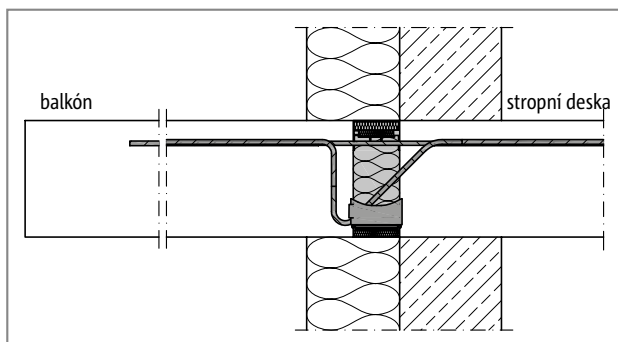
Schöck Isokorb® T typ KL a typ QL: Lodžie uložena ze tří stran
